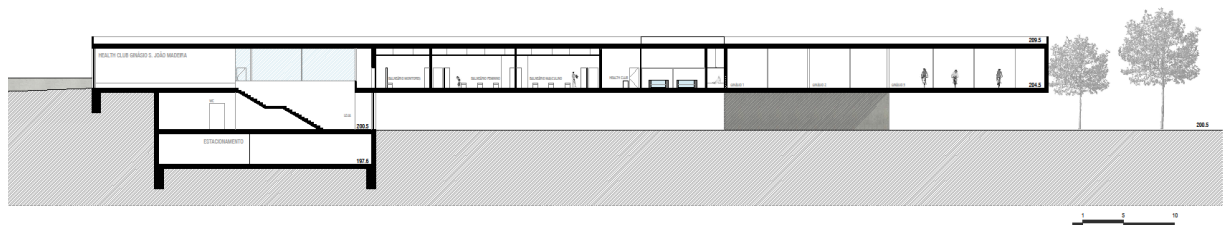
Proposta: Corte Longitudinal Ginásio e “Health Club”, Fonte: Autor
